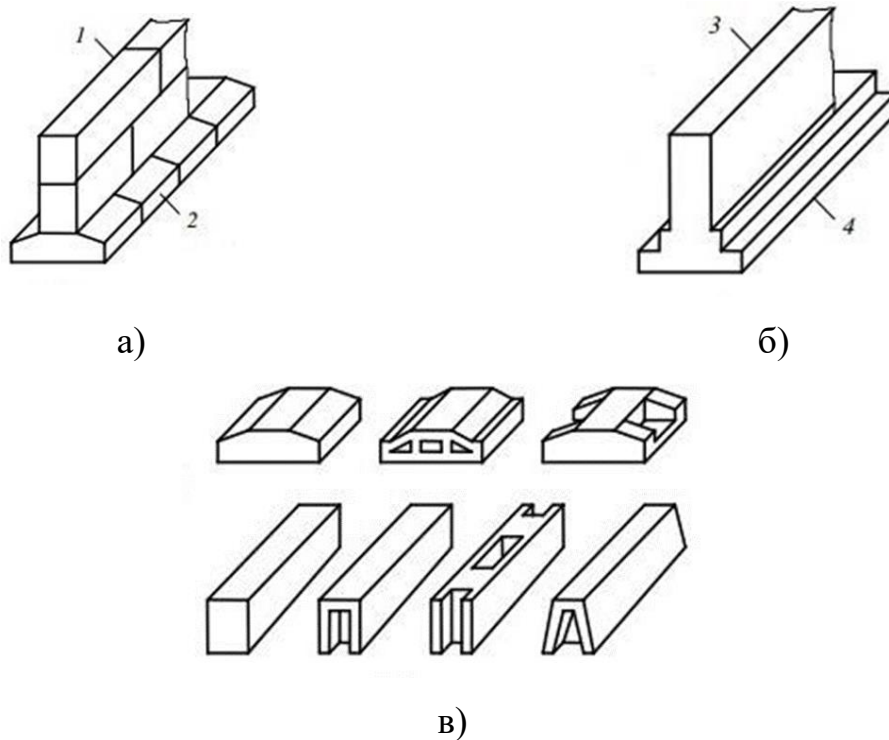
Стрічкові фундаменти: а – збірний безперервний; б – монолітний; в – елементи збірної конструкції фундаментів; 1 – фундаментні блоки стін підвалу; 2 – фундаментні плити (подушка); 3 – стіна підвалу; 4 – подошва монолітного фундаменту
